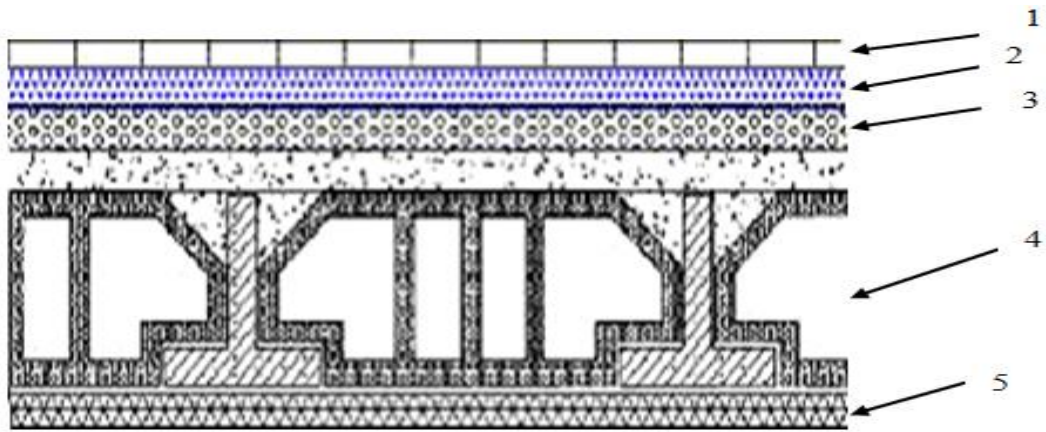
coupe d'un plancher à corps creux du plancher étage courants
